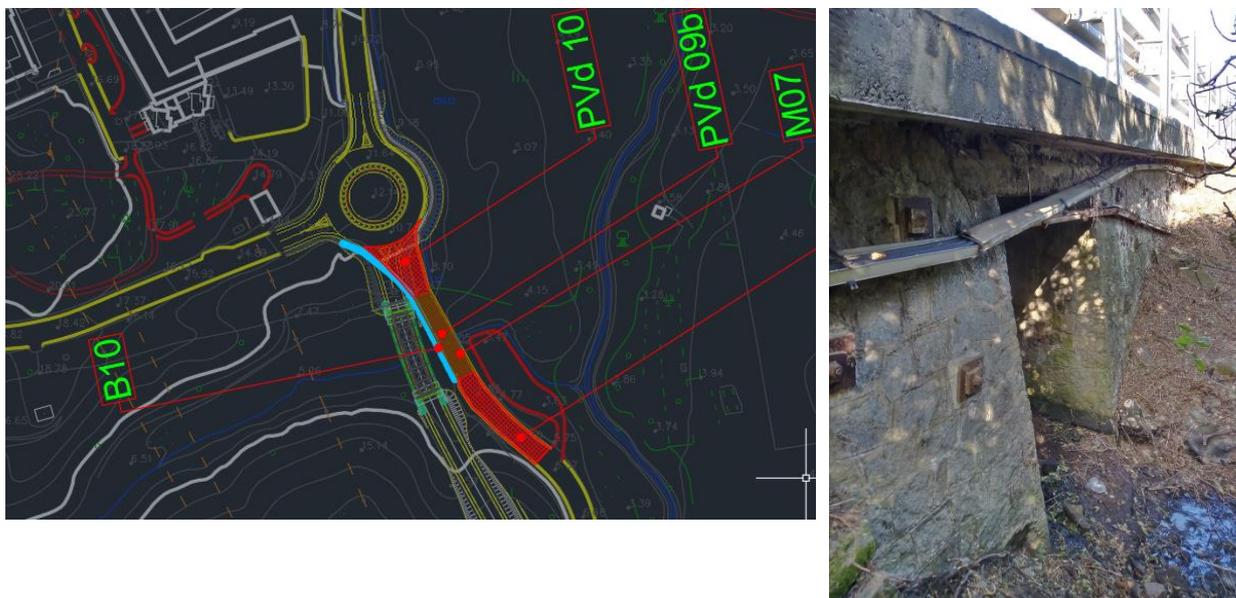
Stralcio planimetrico con indicazione del tombino di cui si prevede la demolizione e foto dello stesso
